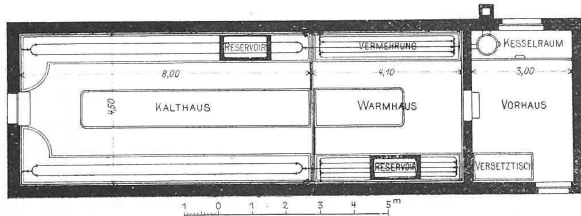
Grundriss des Gewächshauses der Villa Montfleuri in Bern.
